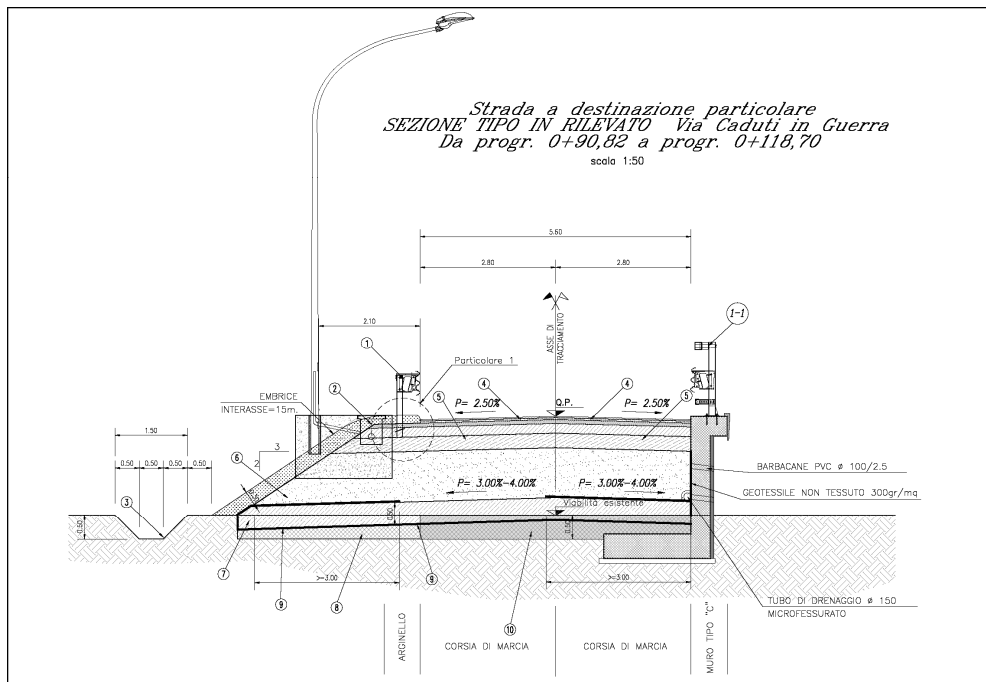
Sezione tipo in rilevato a destinazione particolare di Via dei Caduti in Guerra.
